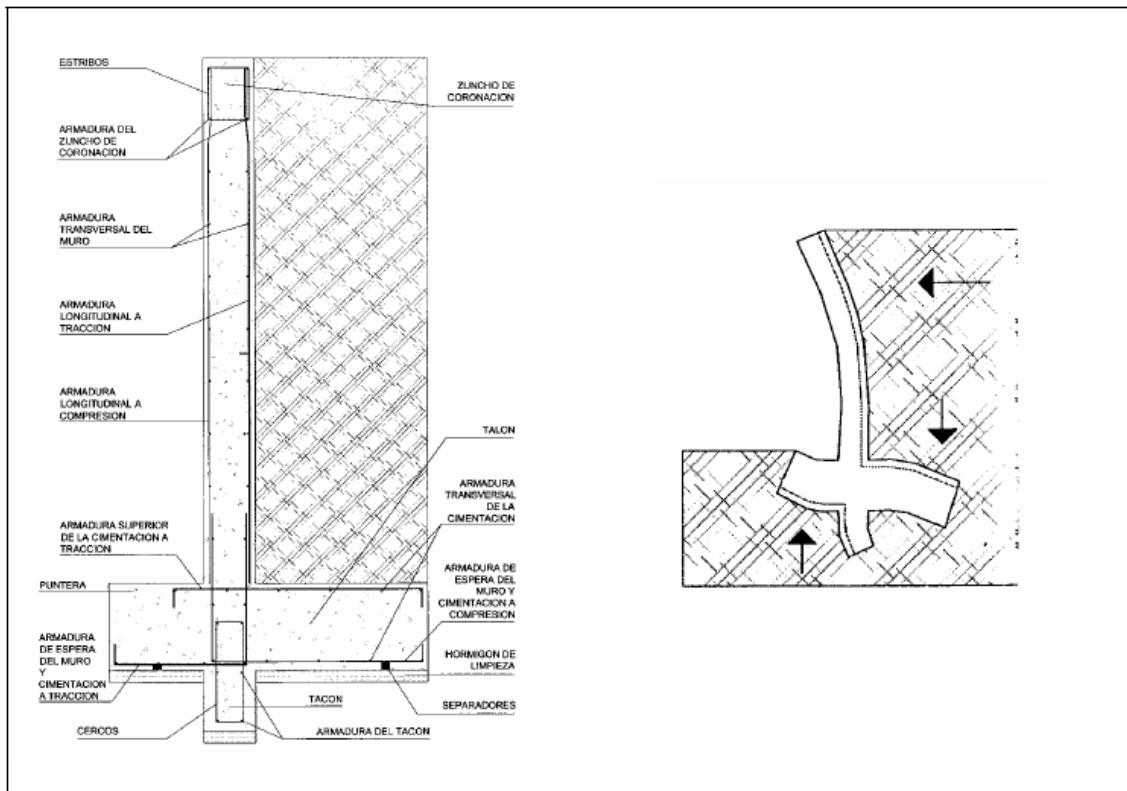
Armadura tipo y deformada en muros con puntera y talón.
